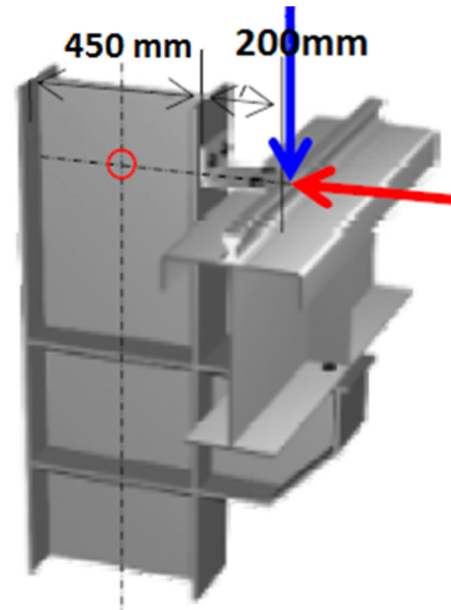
Apoyo Viga Carrilera sobre el pilar.
